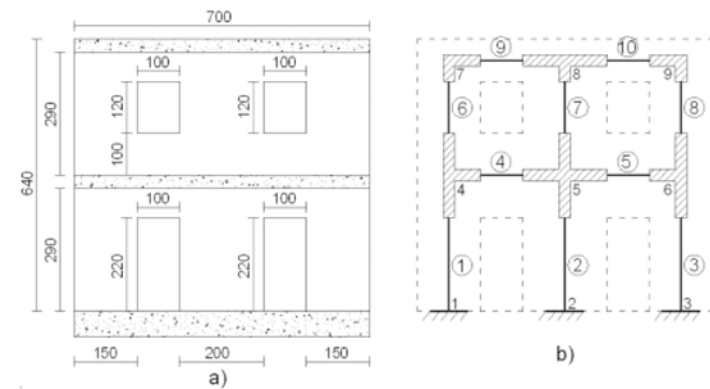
a) Geometria della parete; b) Schema statico della parete.
